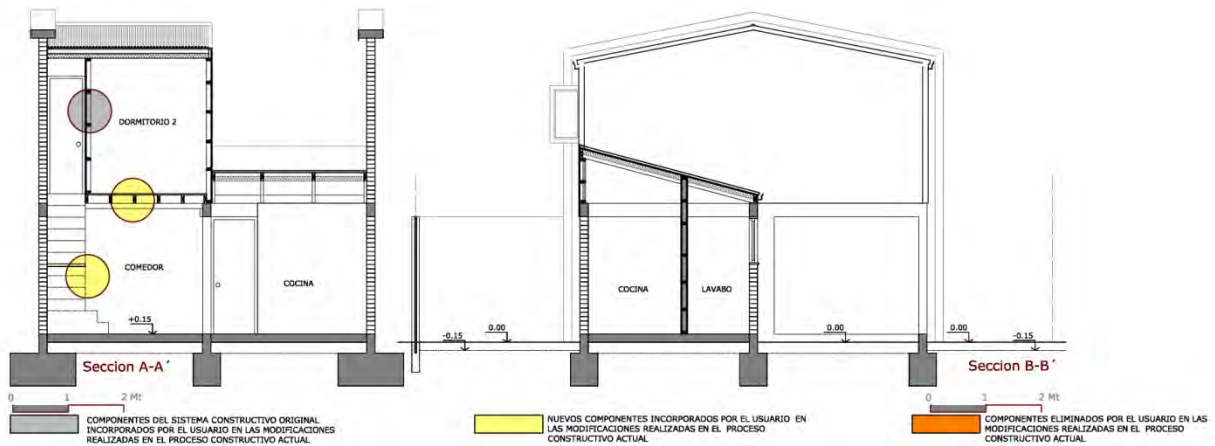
Caso de estudio N° 16_ baja adaptabilidad constructiva
